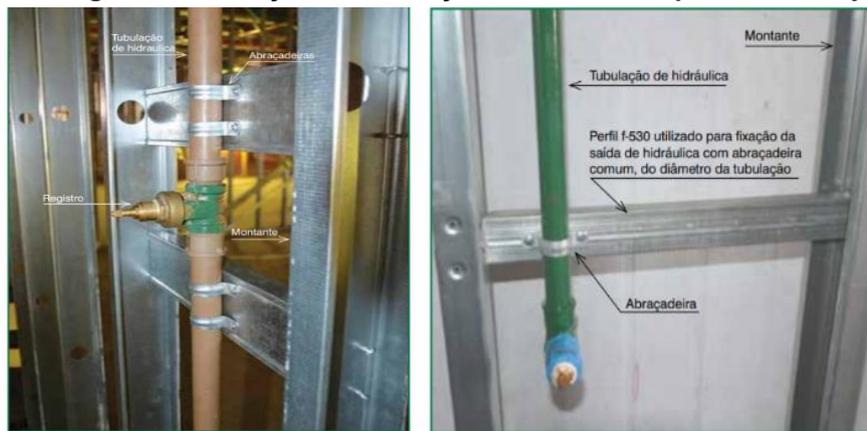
Conectores para passagem de tubulação hidráulica em paredes de *drywall
